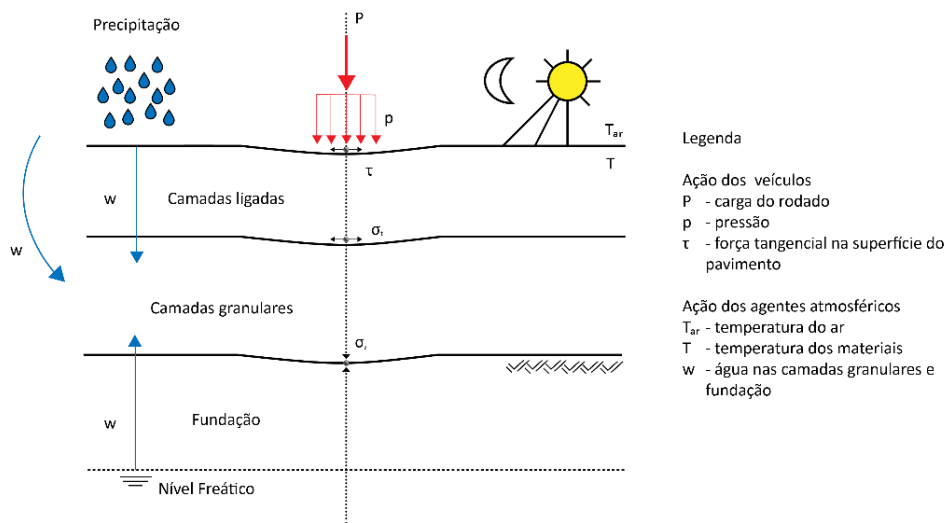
Ações atuantes no pavimento (adaptado de BRANCO, 2008)
